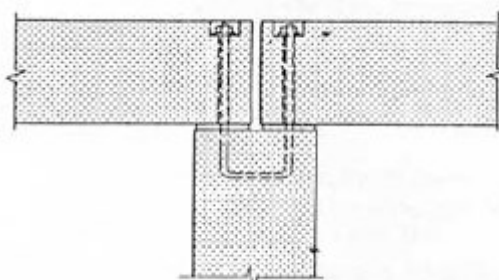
Ligação viga secundária – viga principal através de parafusos (STUPRÉ, 1981).
